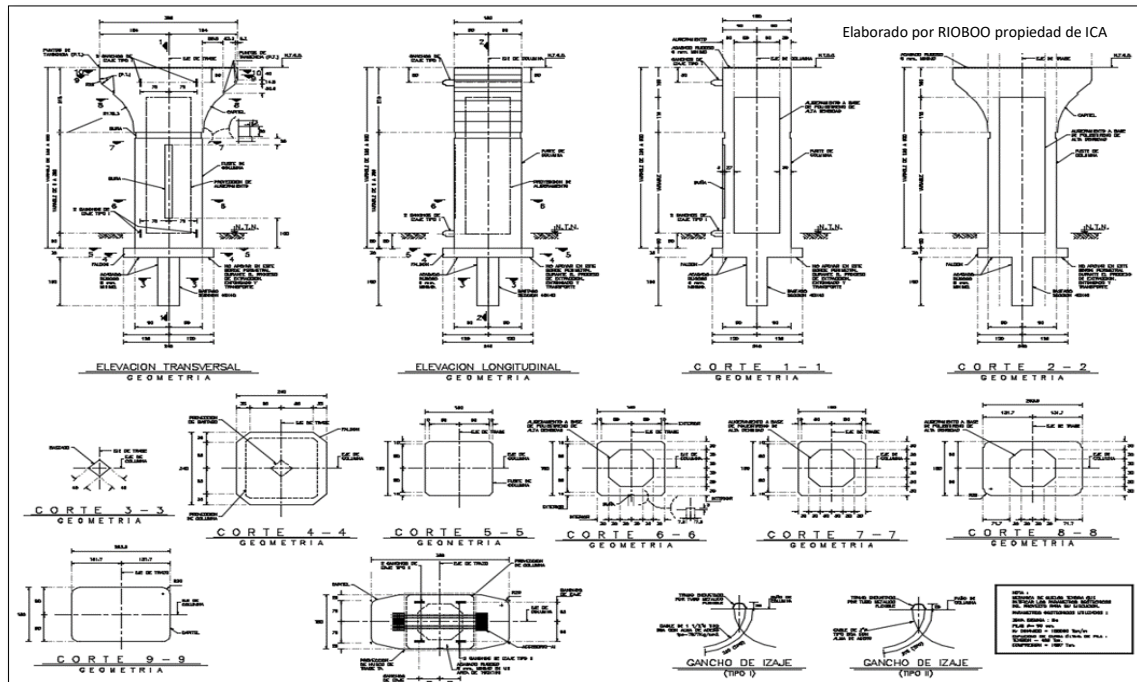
Plano estructural de una zapata tipo entronque Insurgentes
